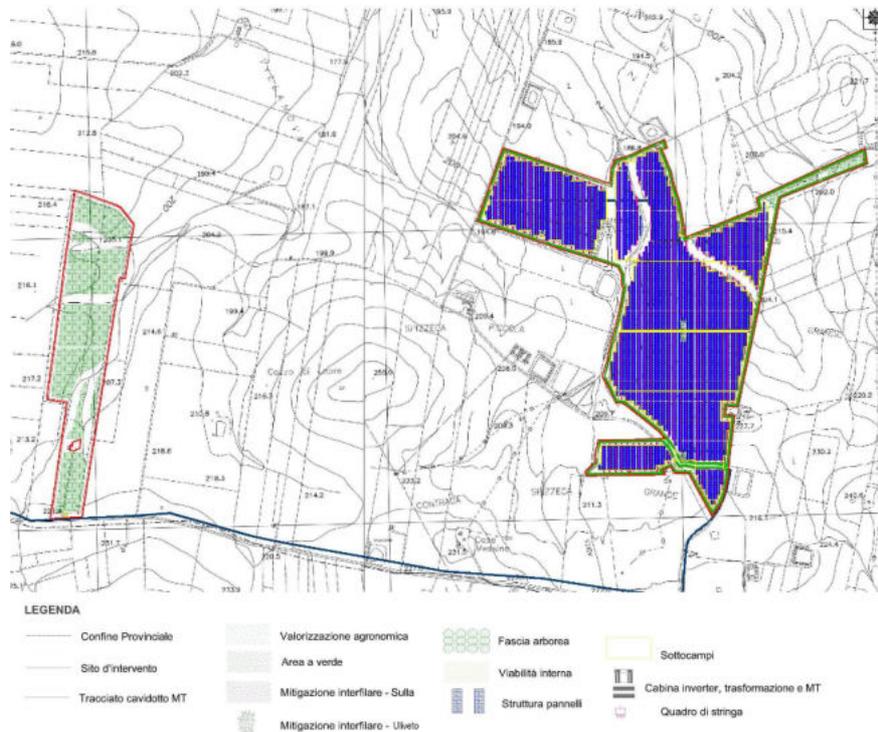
B– Layout dell'impianto ricadente in Contrada Spizzeca con cavidotto
